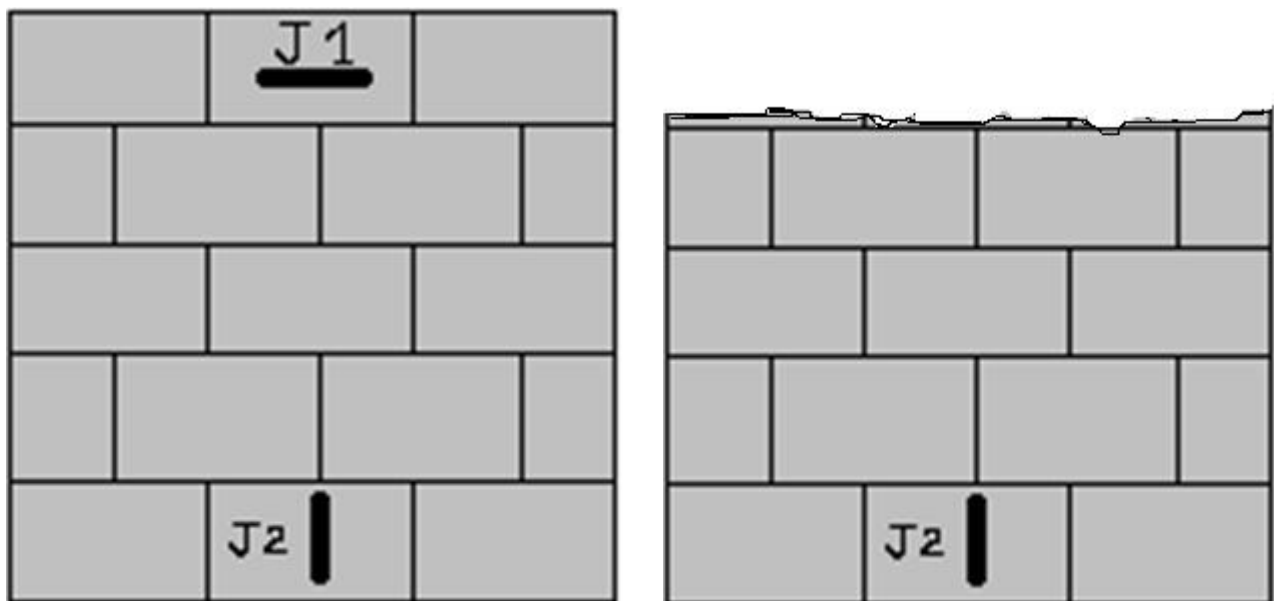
Emplacement des jauges pour l'essai n°13. Fig. IV.93. Rupture mur 12 trous de l'essai n°13.
